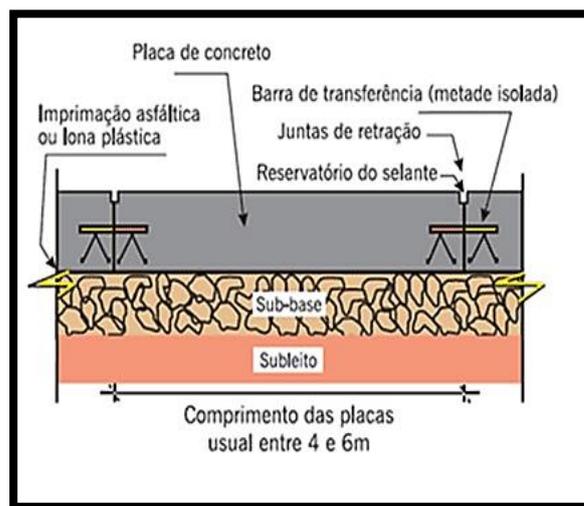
Estrutura do pavimento rígido. Fonte: Bernucci, 2010⁶.
